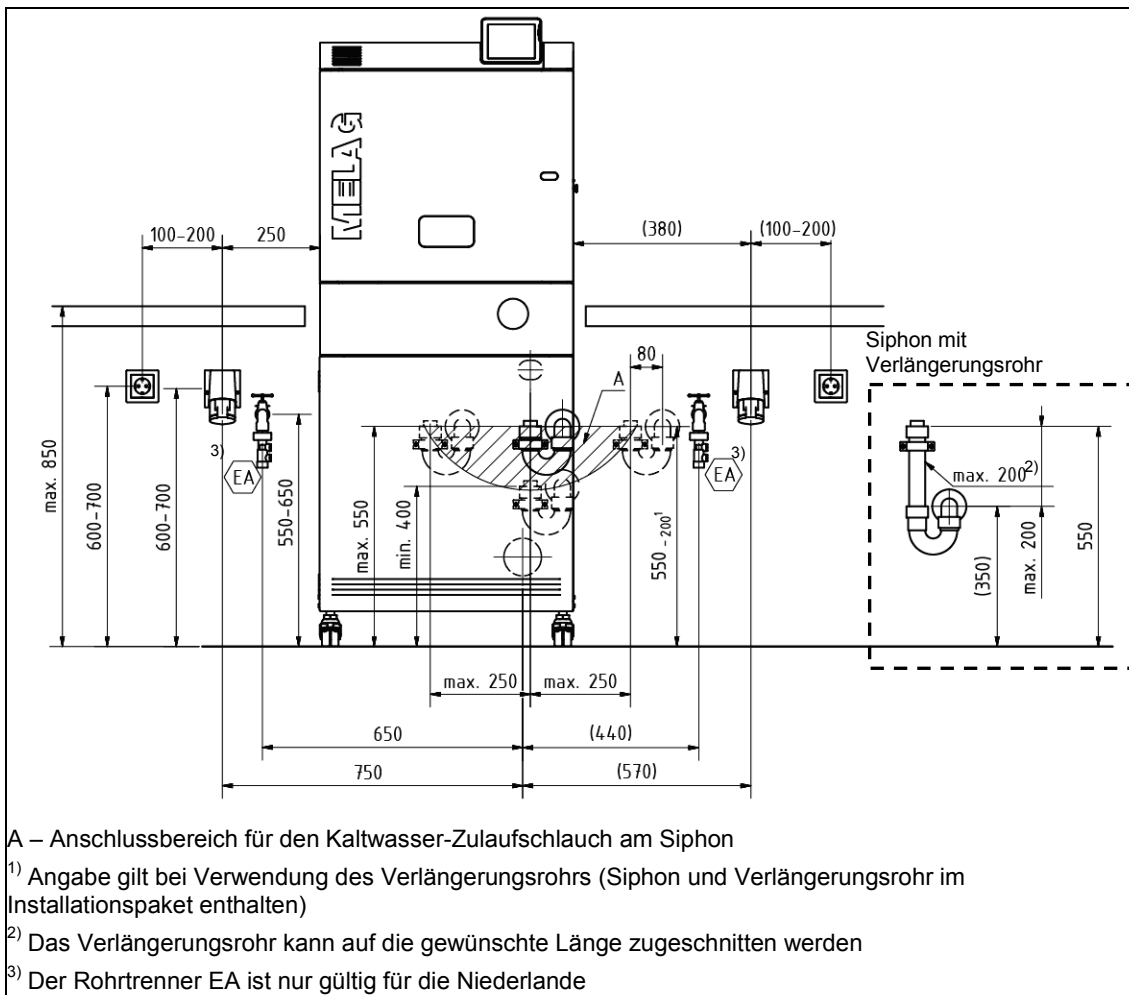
Installationsvoraussetzungen (Maße in mm)
